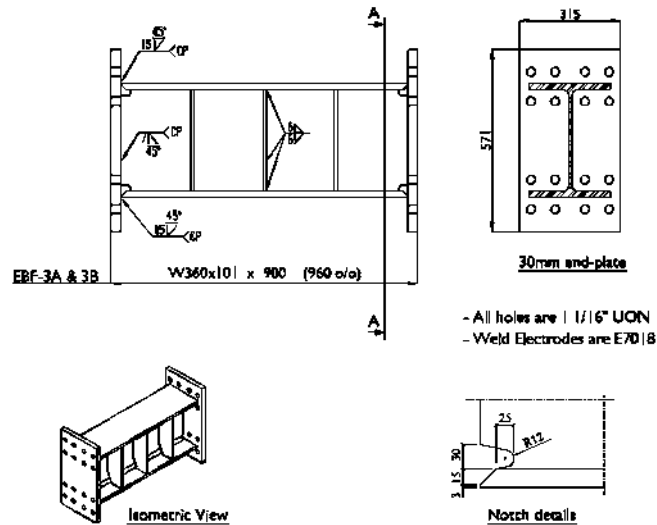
Espécimen del eslabón I, detalles (Mansour; 2010).
